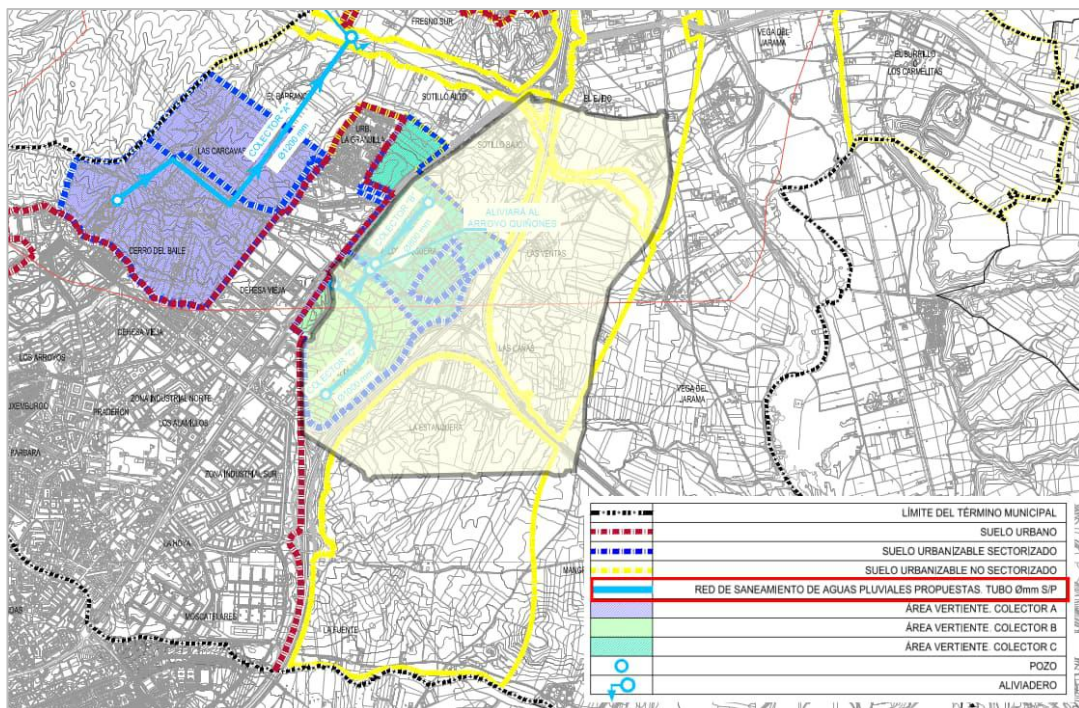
Infraestructuras de Saneamiento Pluvial Propuesto.
